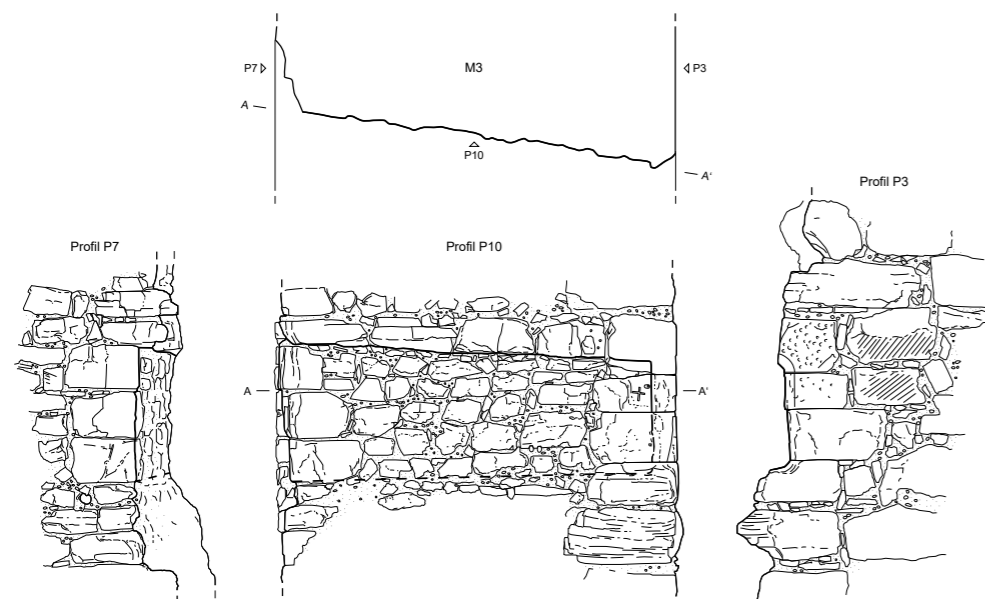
Aufnahmeplan Fenster durch die Bruchkante, Südfassade
